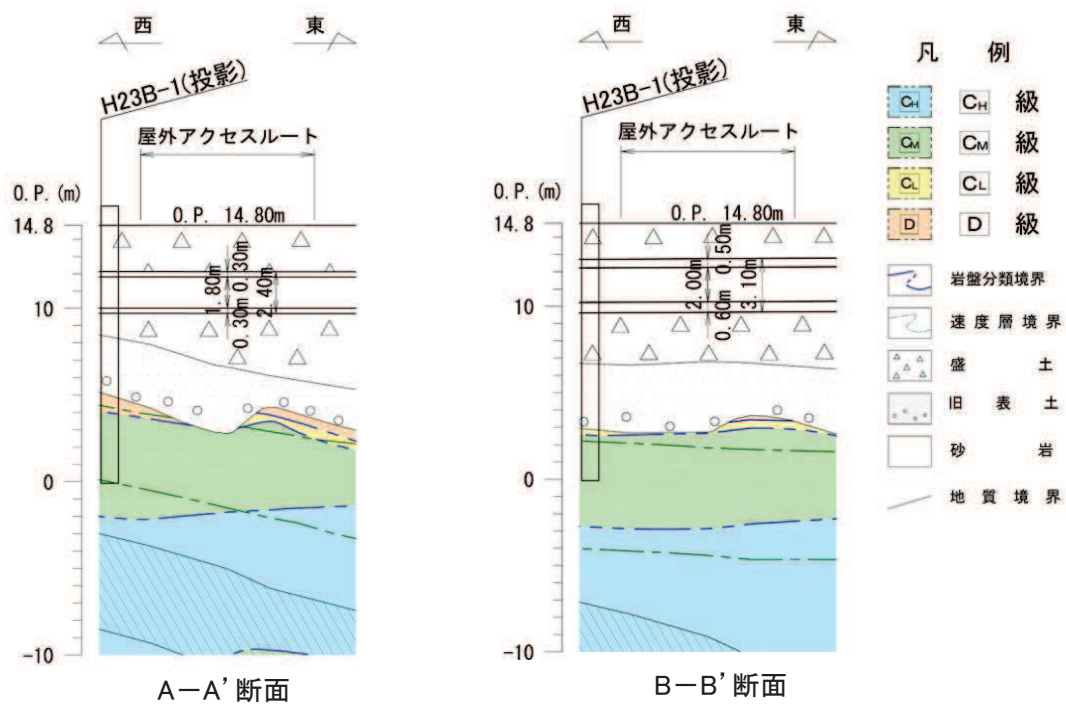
地質断面図 (A-A' 断面, B-B' 断面) 及びボーリング調査の代表位置
